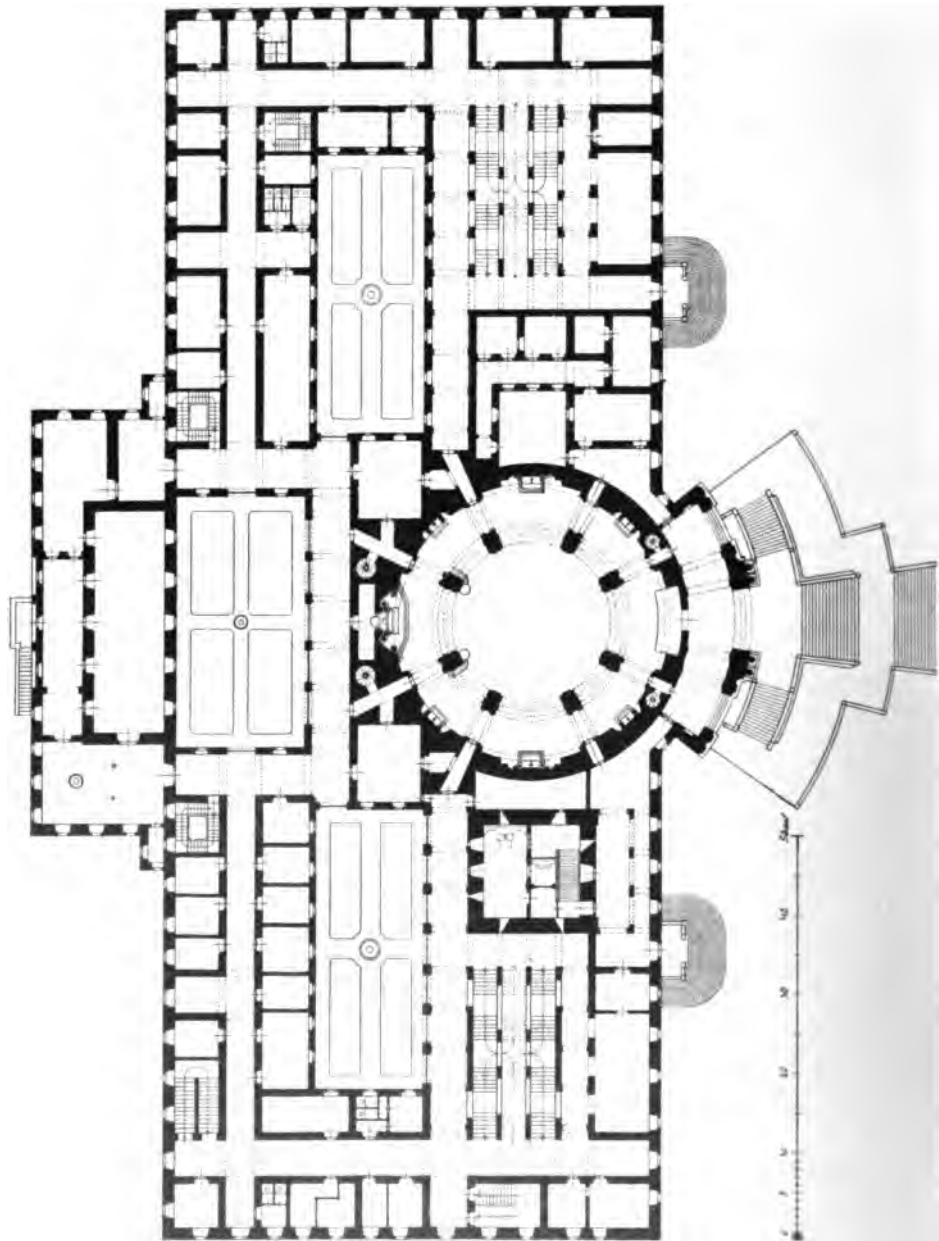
Jesuitenkolleg in Loyola Grundriß (Aufnahme des Verfassers)
